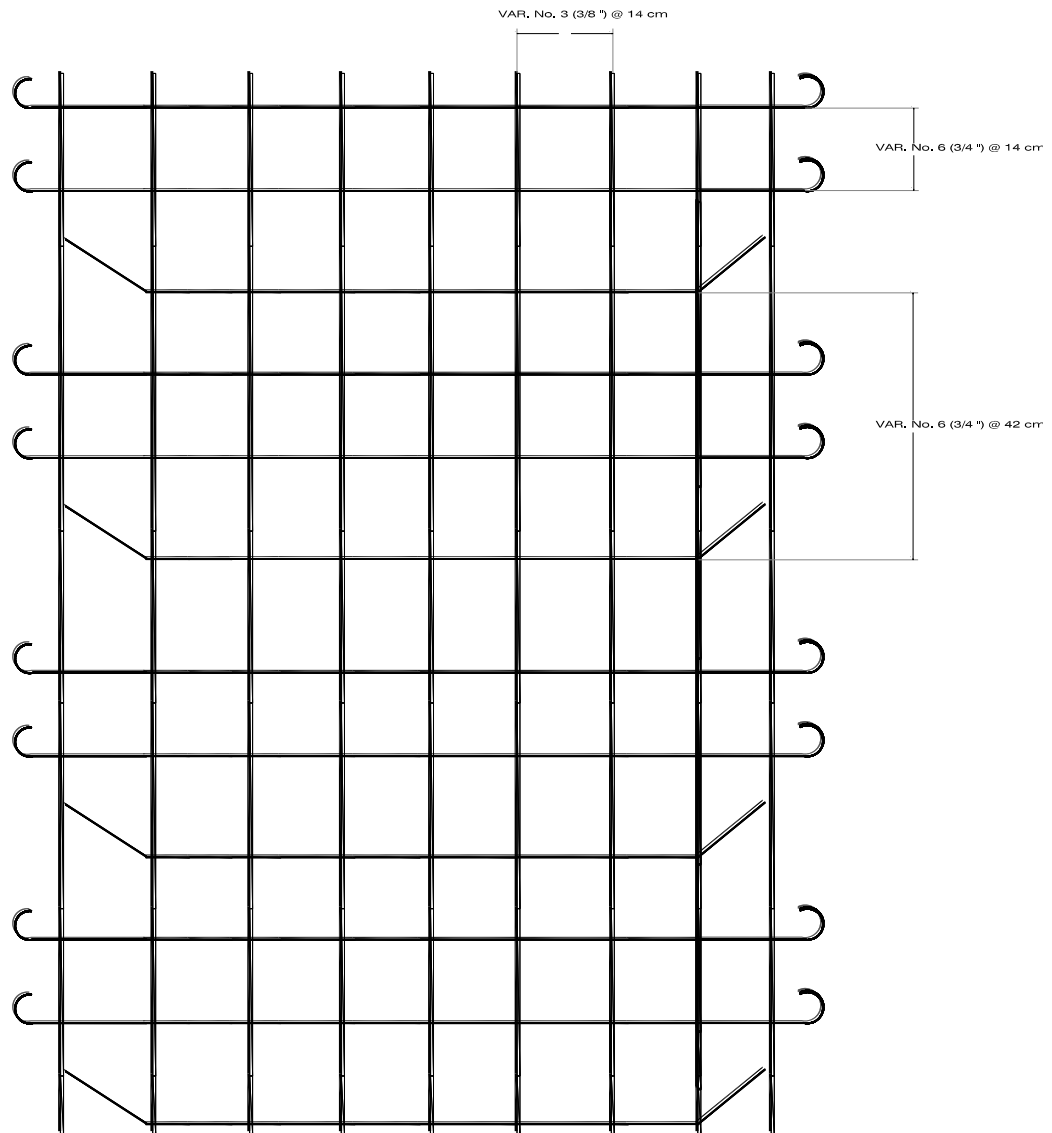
Armado de losa y separación de las barras (en planta) para alcantarilla 2.
